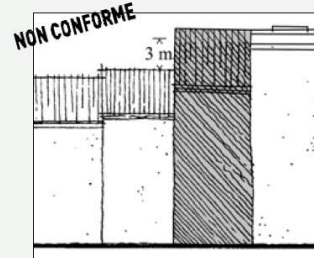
C : projet non conforme : la façade avant et la toiture dépassent de plus de 3 mètres le profil mitoyen le plus bas, sans pour autant dépasser le profil mitoyen le plus haut.
